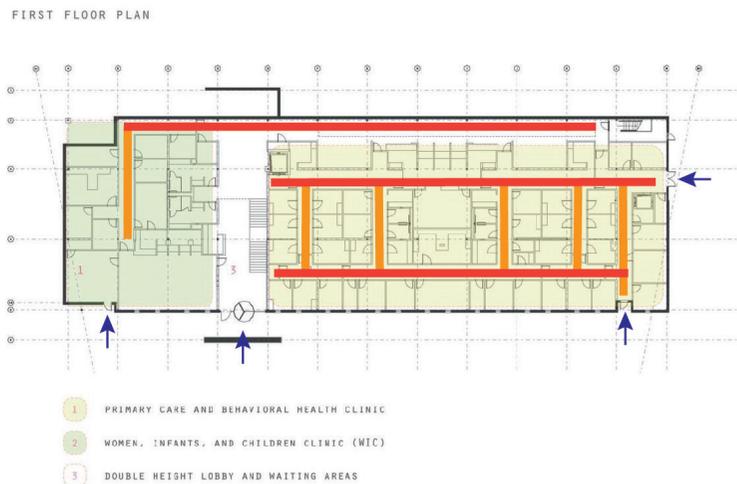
Circulación, zonificación, y accesos de la planta baja. Plataforma Arquitectura (2013)
